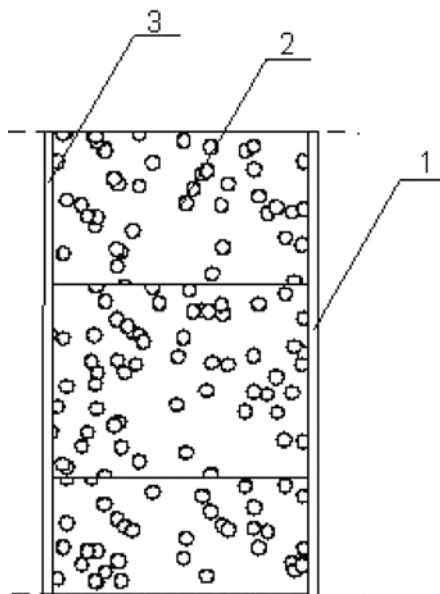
Оштукатуривание кладки из газобетонных блоков: 1 – внутренняя штукатурка, 2 – кладка из газобетонных блоков, 3 – наружная штукатурка
